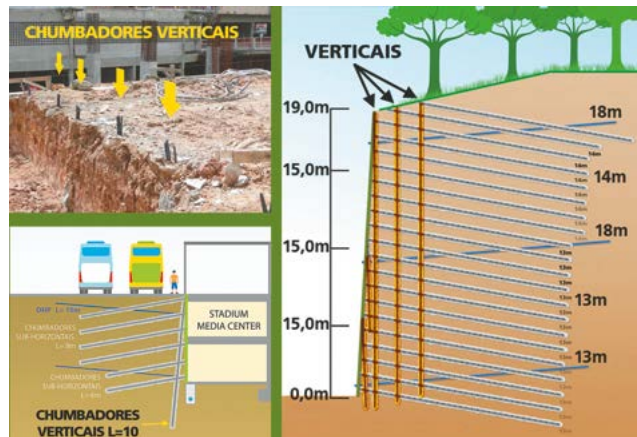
Exemplos de aplicação do chumbador Vertical.
